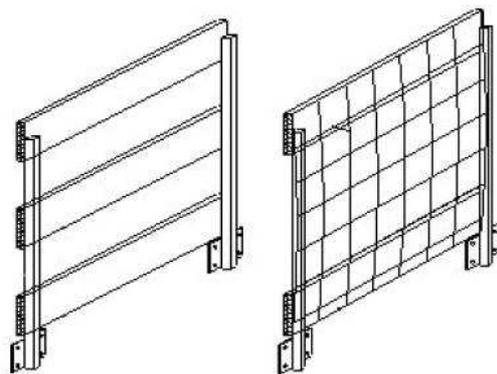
Parapetto con corrente intermedio e parapetto con protezione intermedia costituita da una rete di tipo U (immagine tratta da ISPESL, Linee guida per la scelta, l'uso e la manutenzione dei sistemi collettivi di protezione dei bordi).
